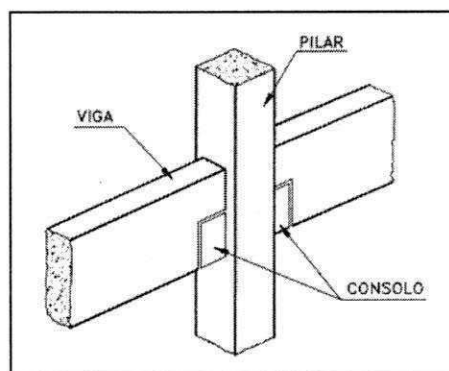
Figura esquemática da montagem das vigas nos pilares
